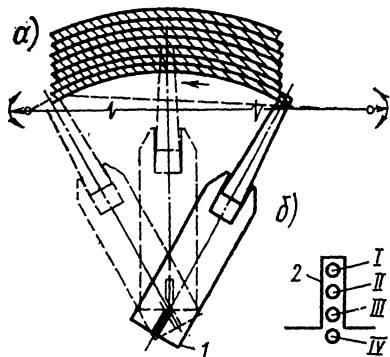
Схема передвижения земснаряда с использованием напорного свайного хода:
